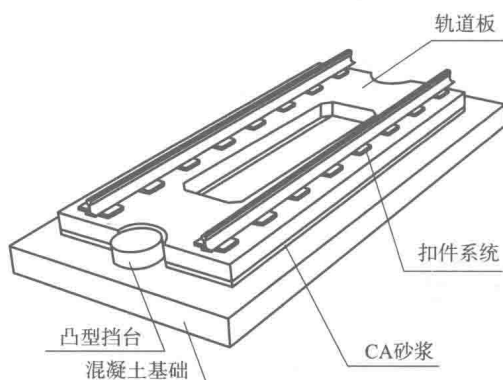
框架型板式轨道(钢筋混凝土轨道板)
